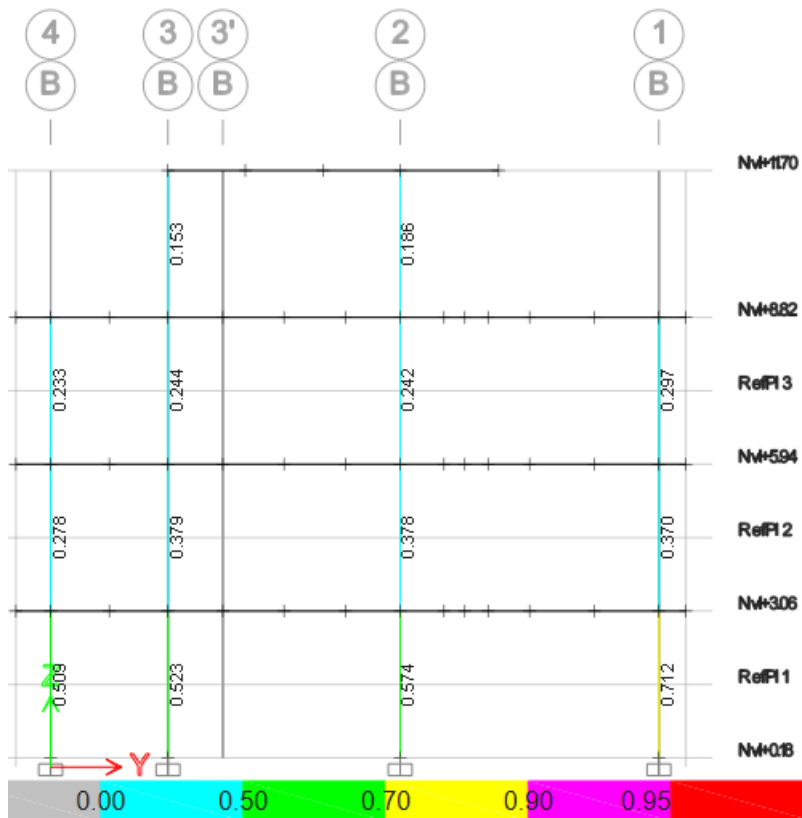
Diseño de columnas rellenas de hormigón del eje B
